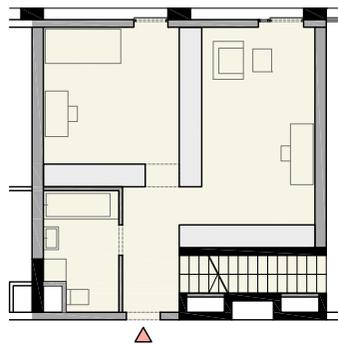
Typ F, 2-geschoßig, Variante 2, 3./4.OG M 1:200
